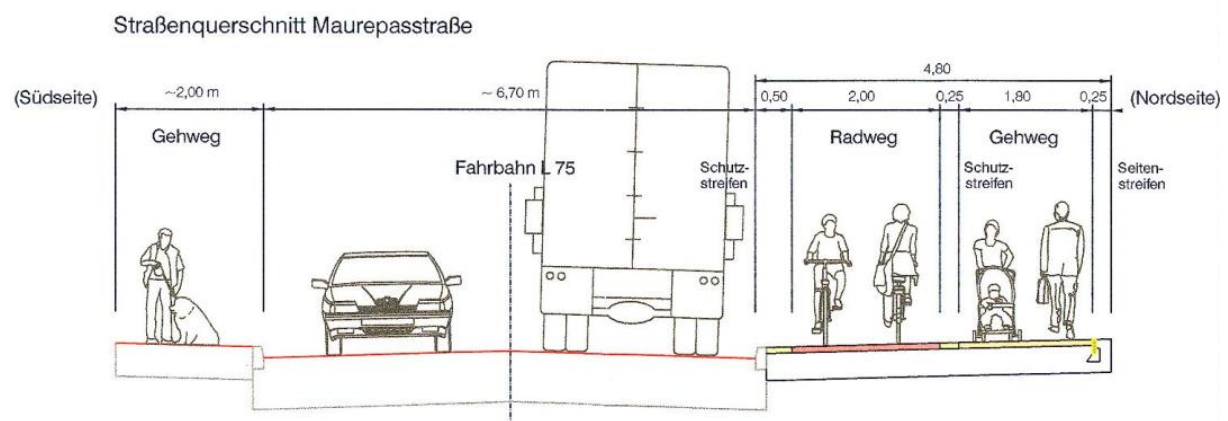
Straßenquerschnitt der Maurepasstraße, o. M, Quelle: Bebauungsplan Nr. 90 „Kronskamp“ – 4. Änderung
